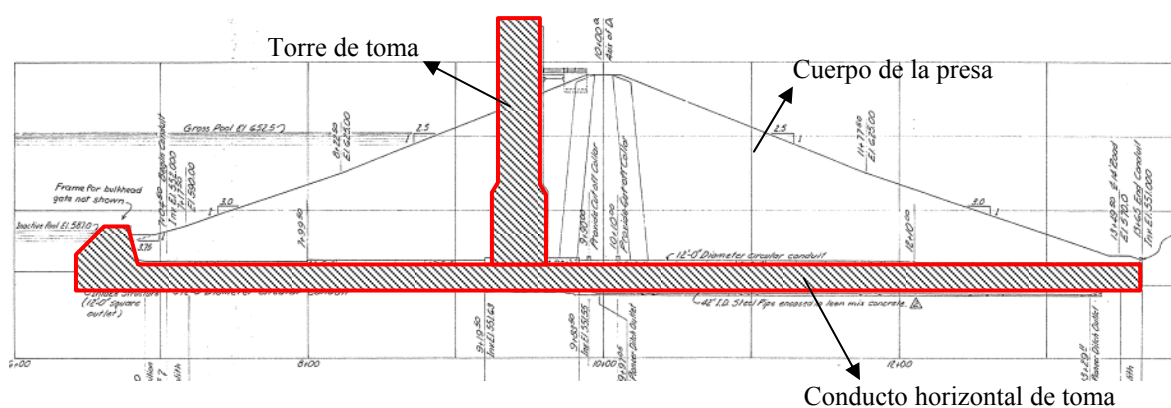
Sección transversal de la presa en la ubicación del conducto y torre de toma
